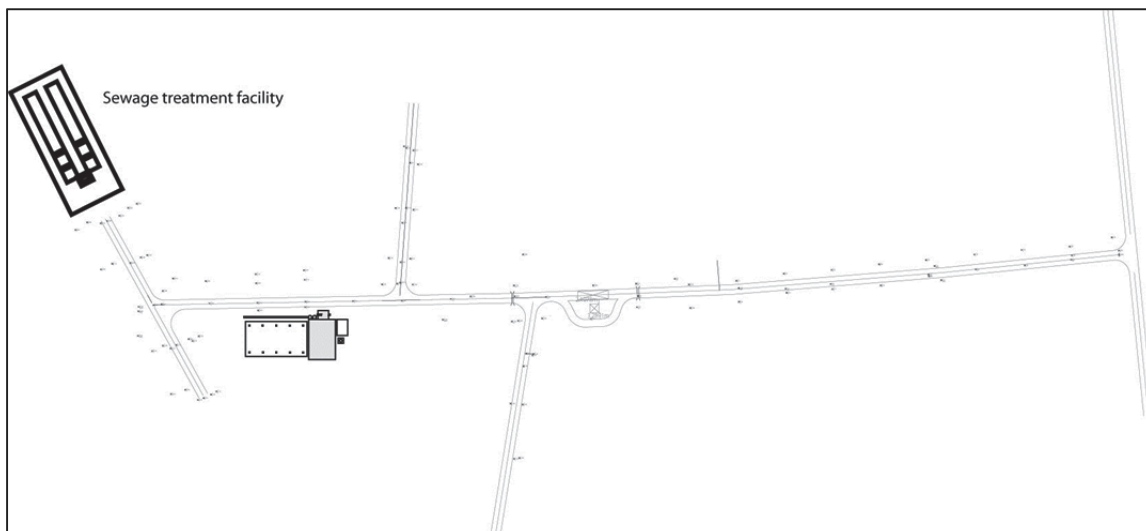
し尿浄化槽汚泥の適切処理施設の位置図
